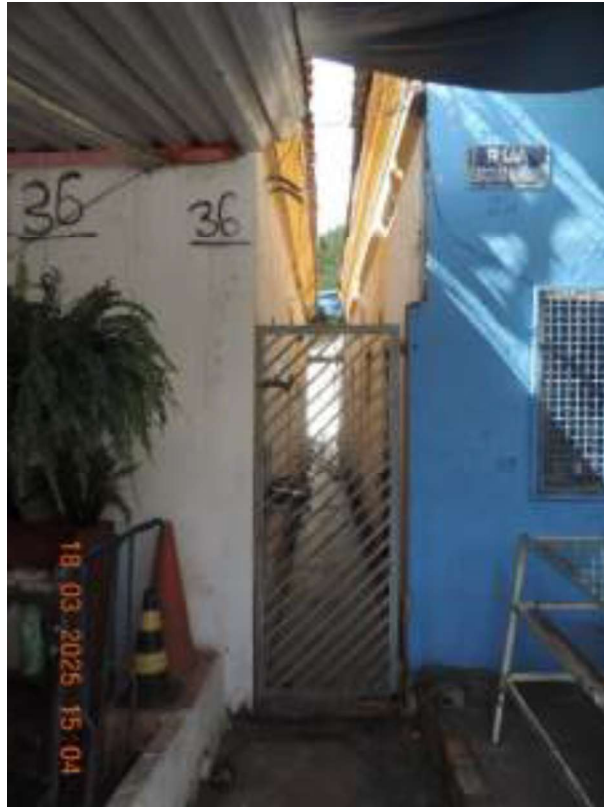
DIVISA ENTRE O 2° E O 3° ESTABELECIMENTO COMERCIAL
